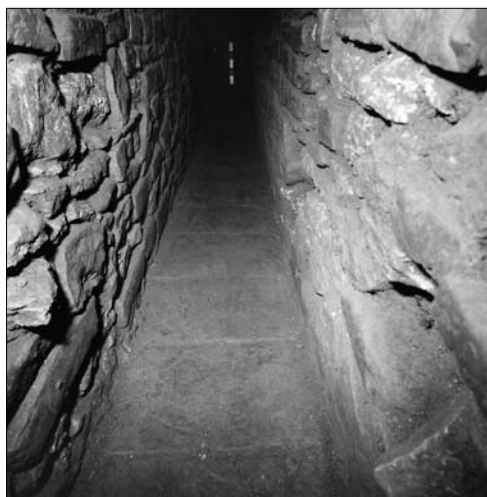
Aosta, Terme del Foro, vano Y1: interno del condotto con dettaglio della pavimentazione in laterizi bipedali (Foto di R. Monjoie).
